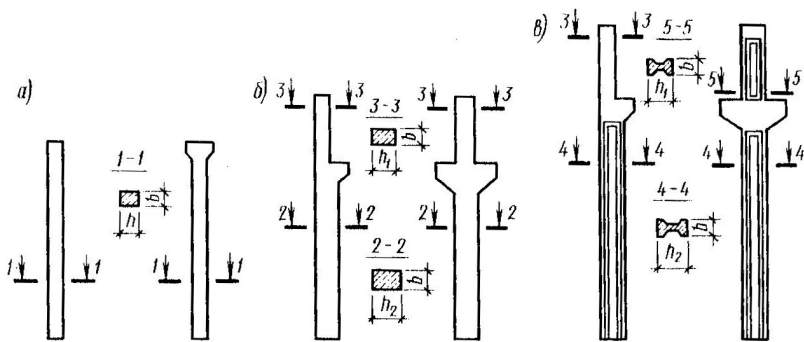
Железобетонные колонны одноэтажных каркасных производственных зданий
